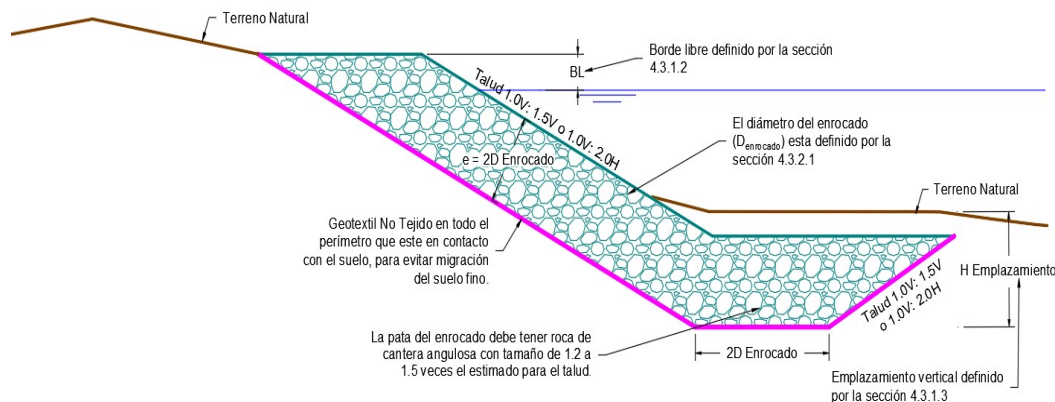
Sección típica de muro longitudinal en enrocado o rip-rap natural
